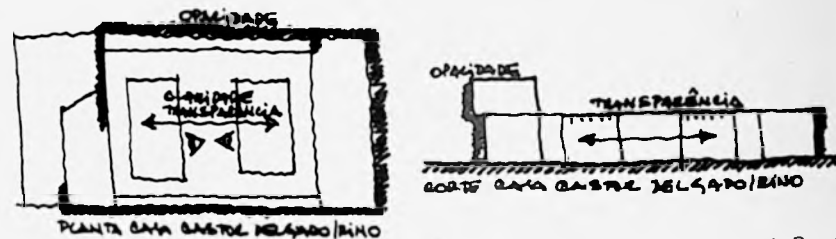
e 477 Croquis planta e corte casa Castor Delgado Perez.
